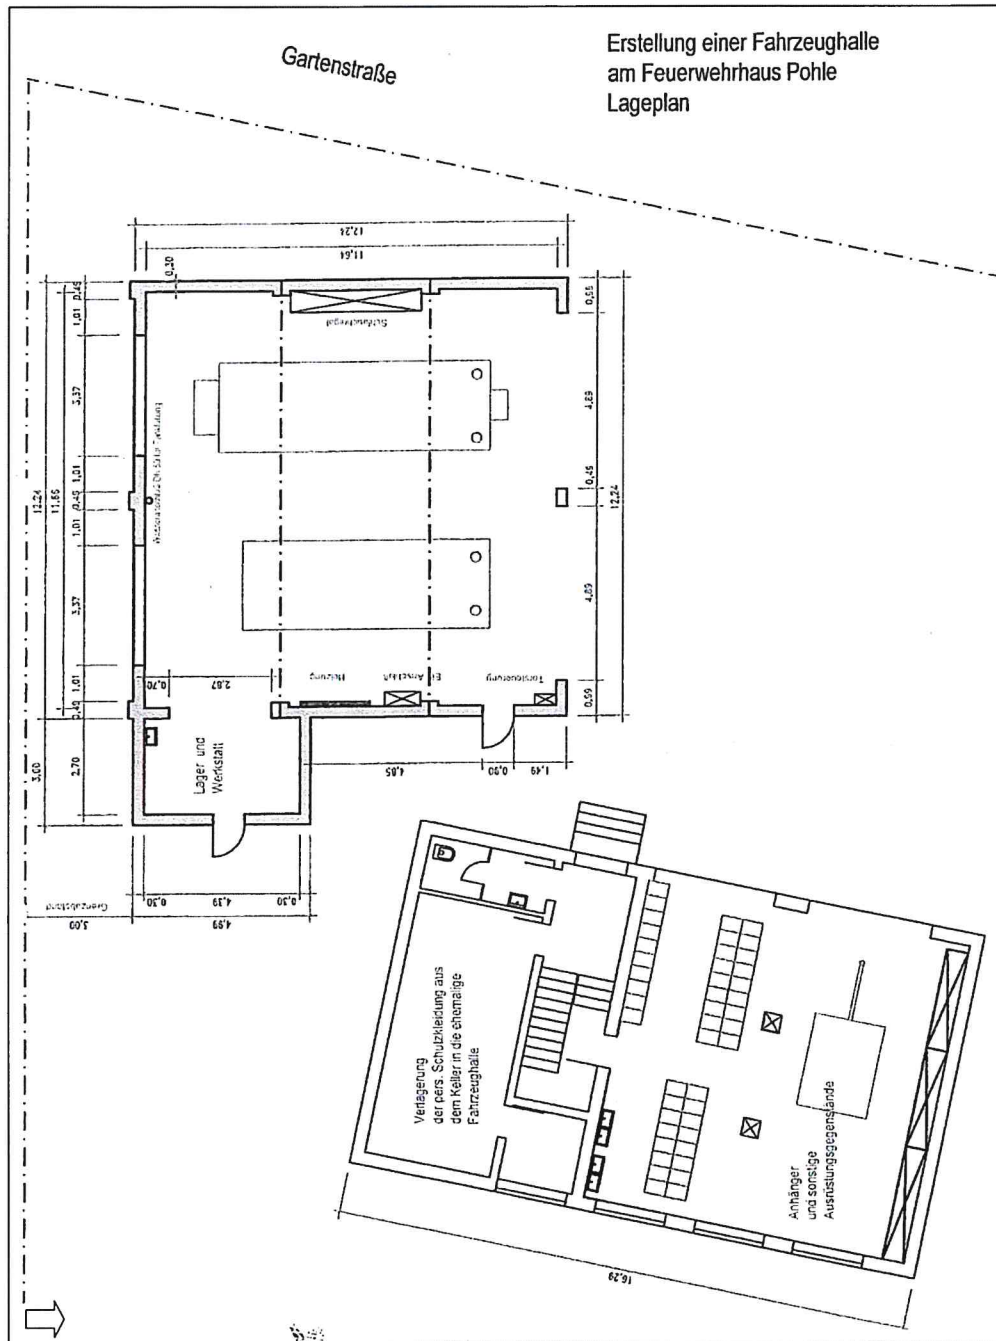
Lageplan der geplanten Fahrzeughalle (oberes Gebäude) und dem Bestandsgebäude (unterer Bildausschnitt) – unmaßstäbliche Darstellung (Quelle Samtgemeinde Rodenberg)
